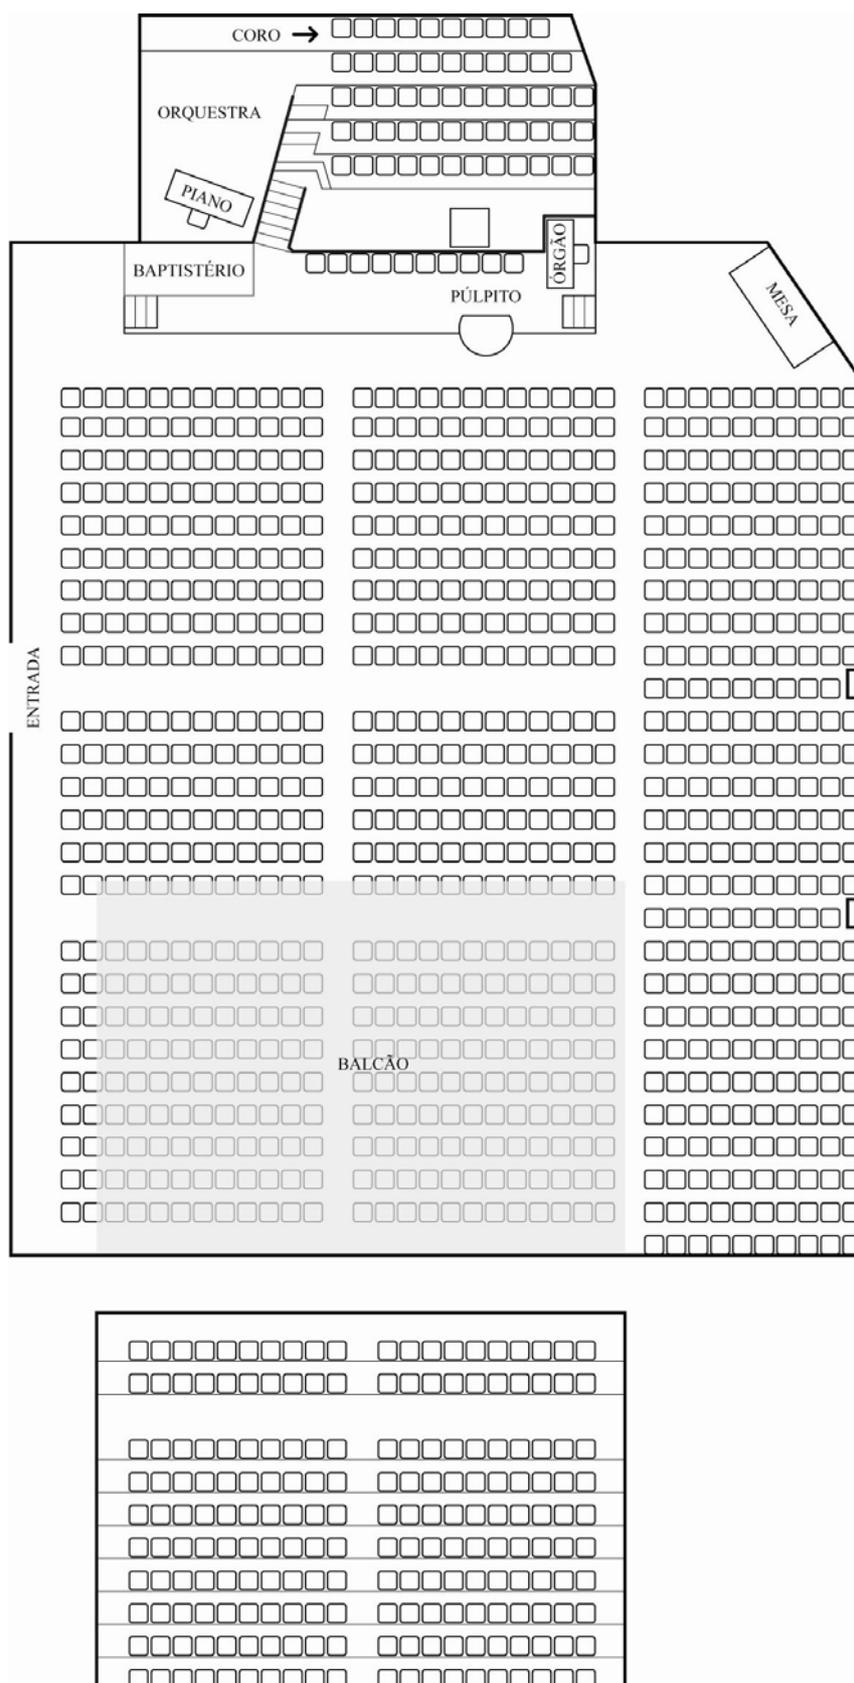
Planta do salão da Neves Ferreira e respectivo balcão
